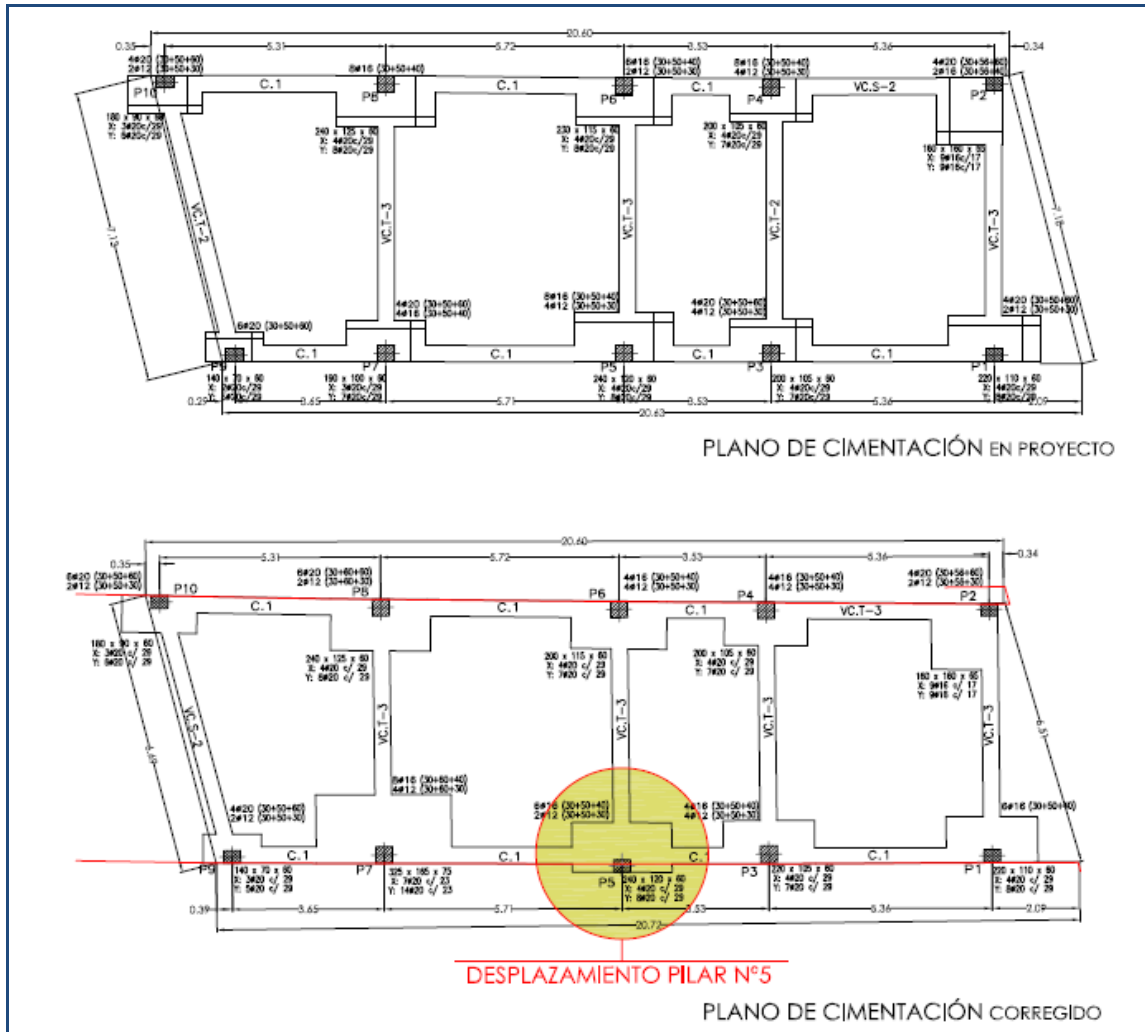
Comparativa entre el plano de cimentación en fase de proyecto y el plano corregido.
